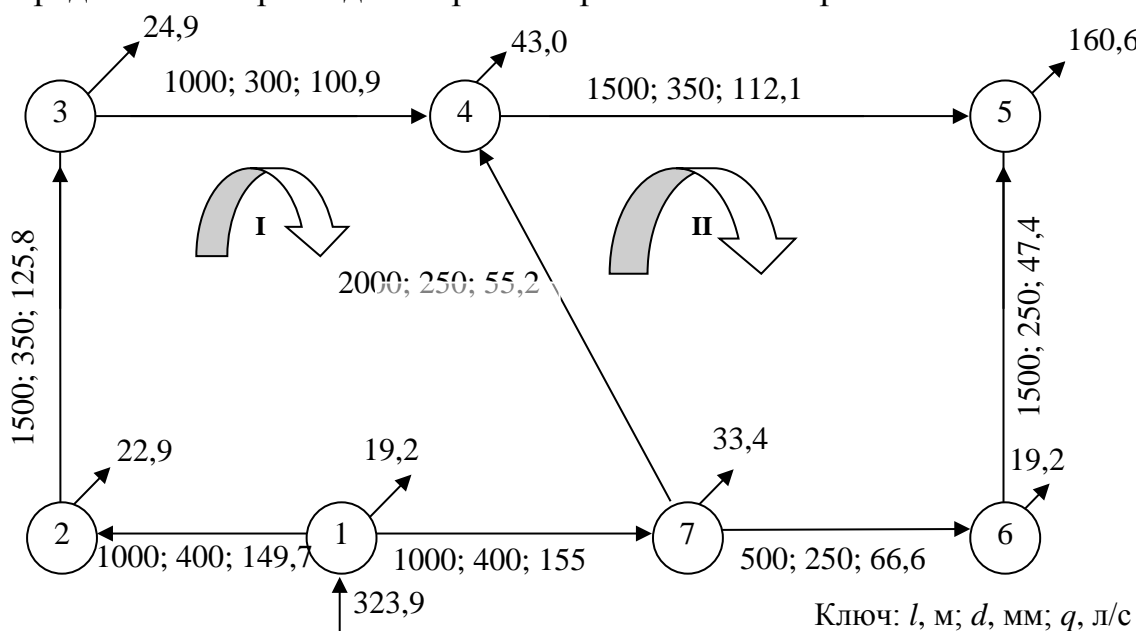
Расчетная схема водопроводной сети с предварительно распределенными расходами при пожаре
